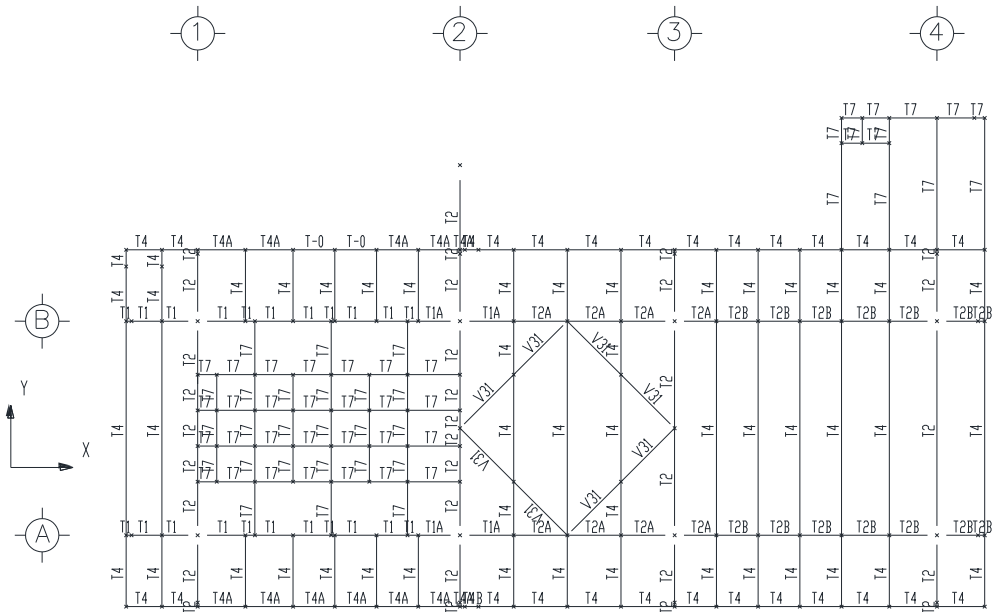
Grupos en Cubierta Superior Elev. (+) 27.145 m, superestructura
